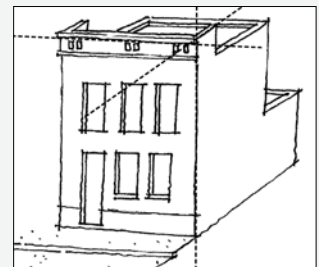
C: doorsnede van het gevelvlak en het dakvlak – geval van een bouwwerk met plat dak met acroteriemuren.
